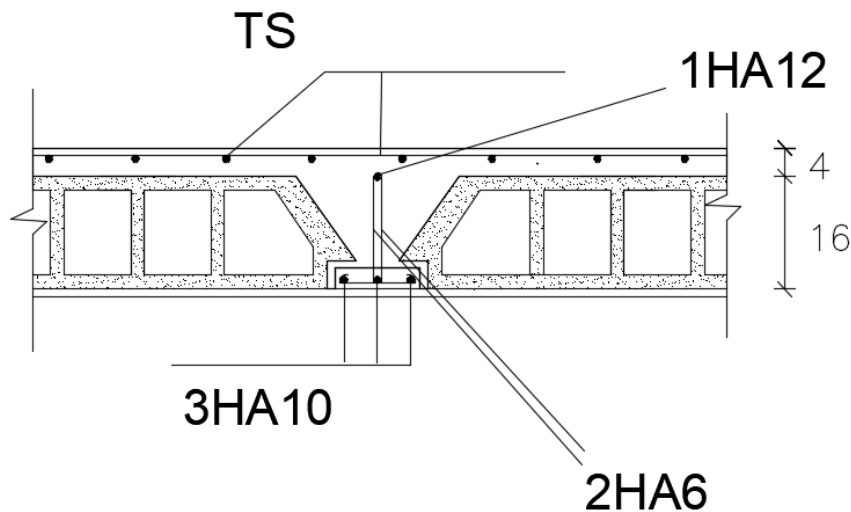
Coupe schématique du ferrailage du plancher.
